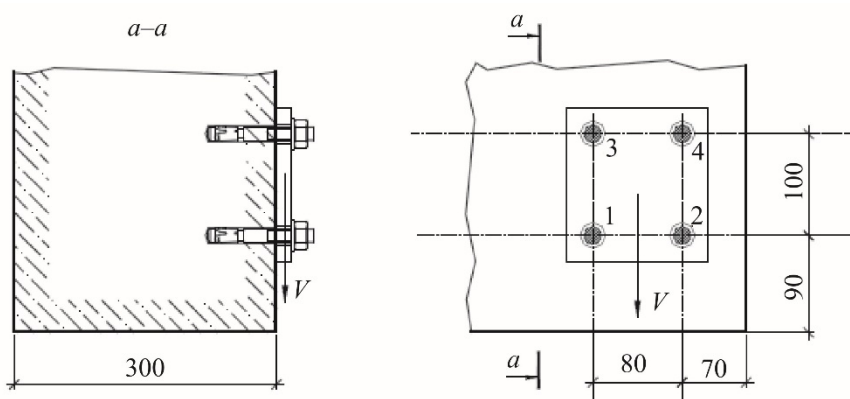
Пример 2. Схема анкерного крепления.
